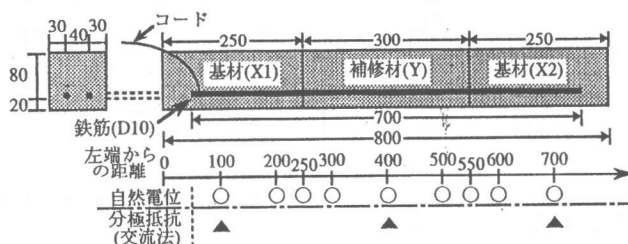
Type-1供試体の形状と測定位置 (単位:mm)
